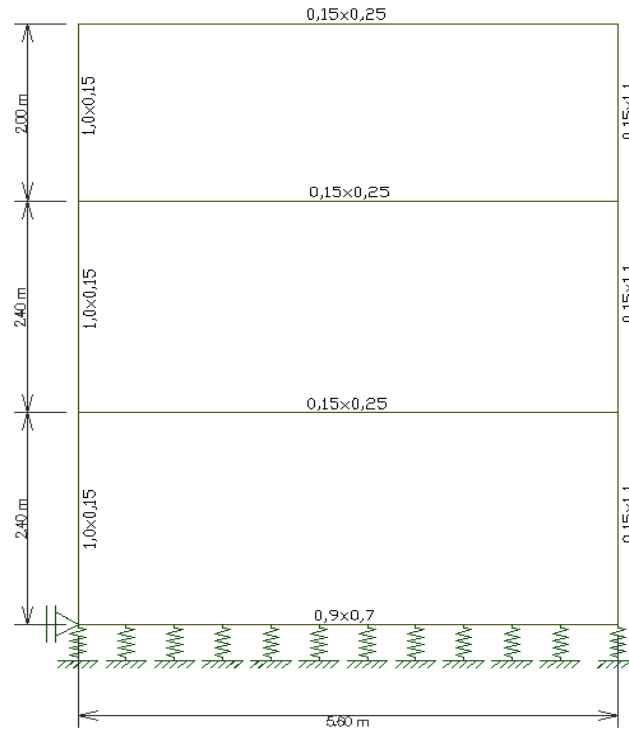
Dimensões e geometria das vigas e pilares do pórtico 4-4'
